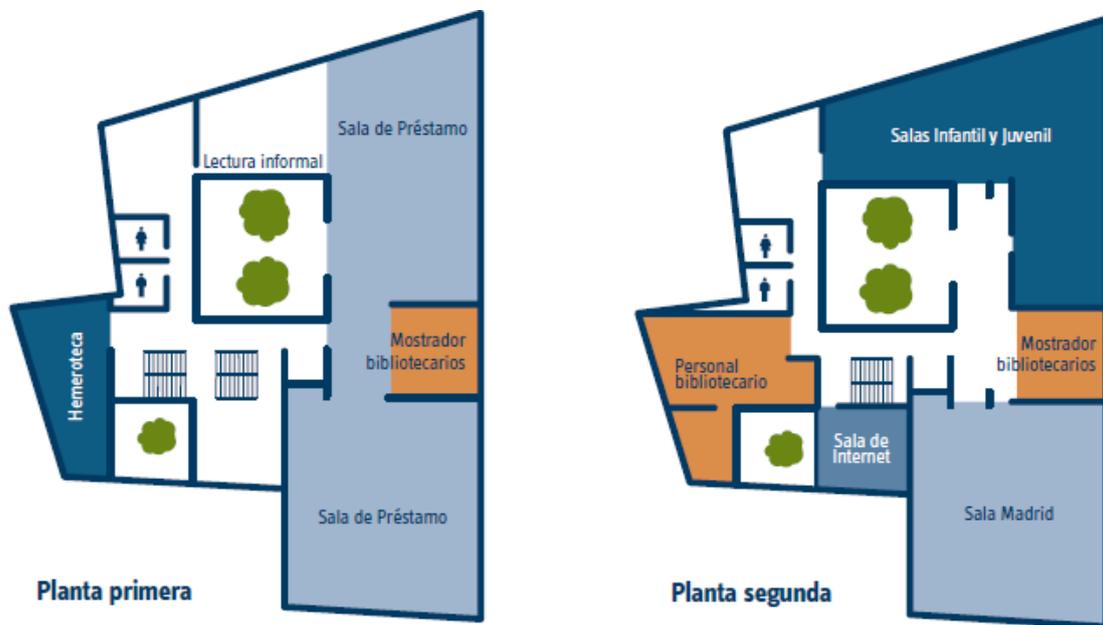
Planta primera y planta segunda de la biblioteca Iván de Vargas. Fuente: Bibliotecas Públicas Municipales
